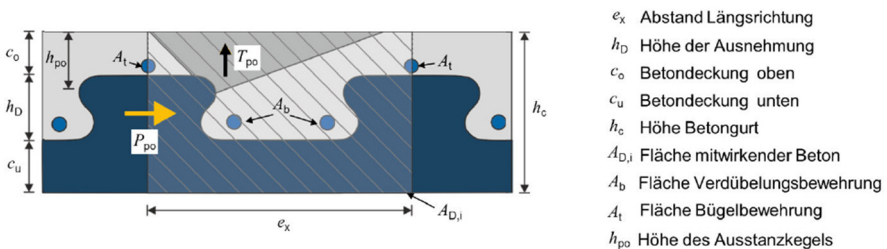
Ausstanzenmodell für den ungerissenen Beton nach Claßen [81]
